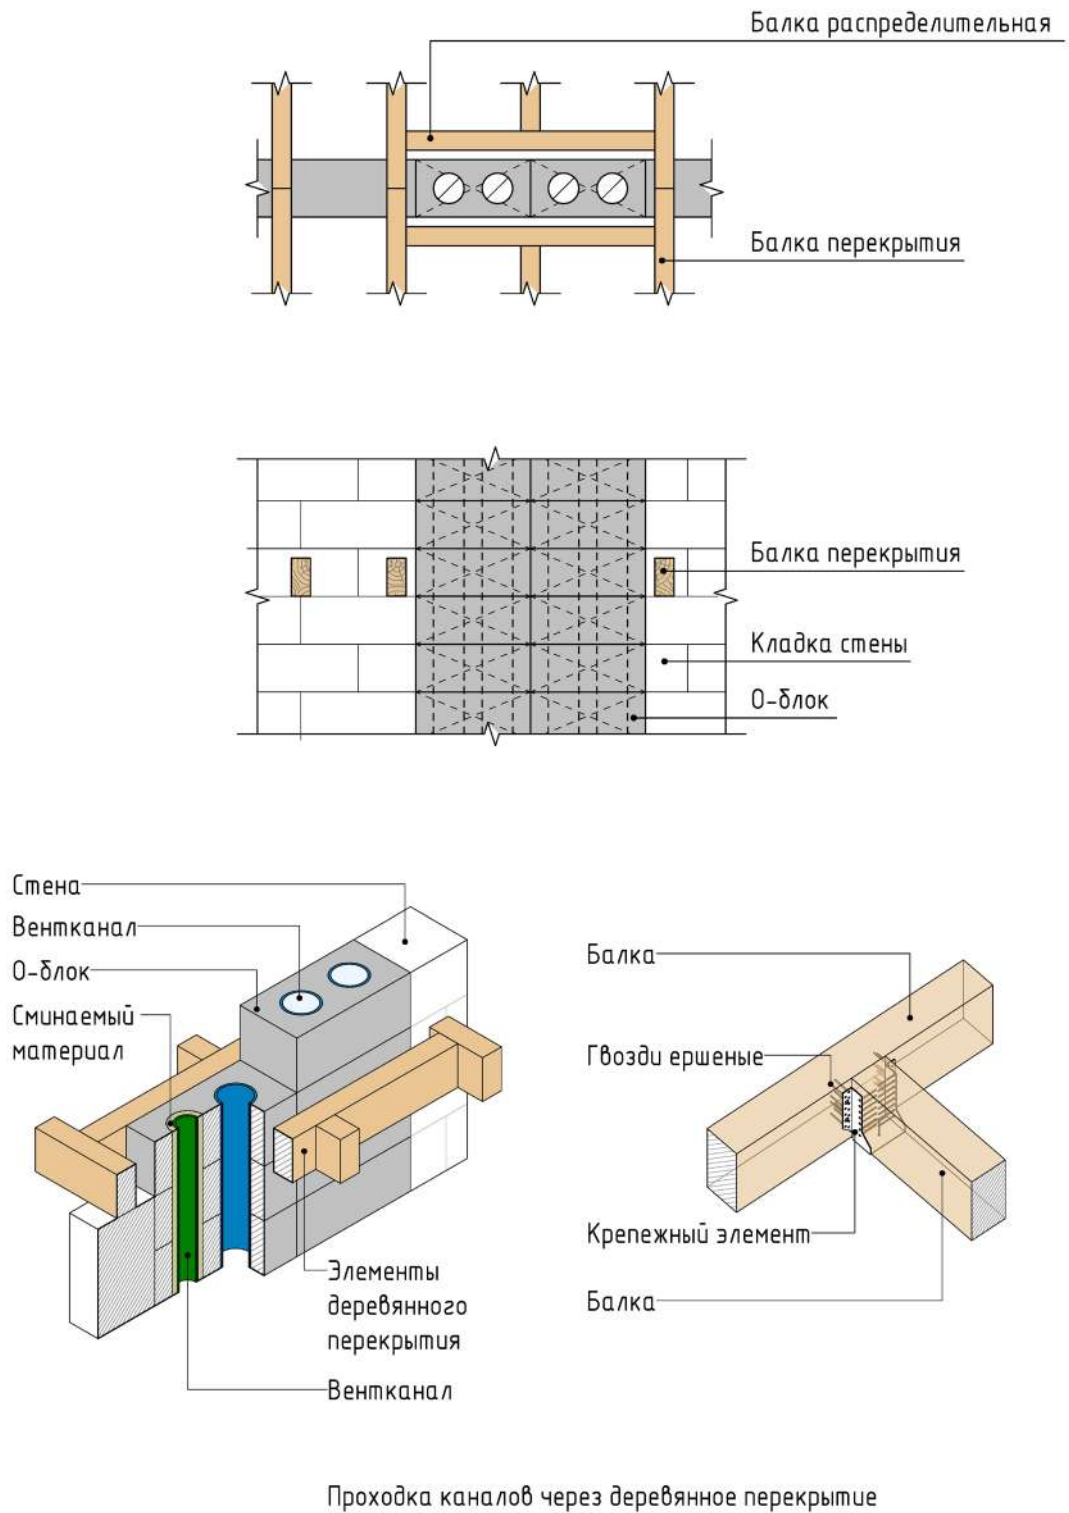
Варианты проходки каналов в составе несущих стен через деревянное перекрытия
